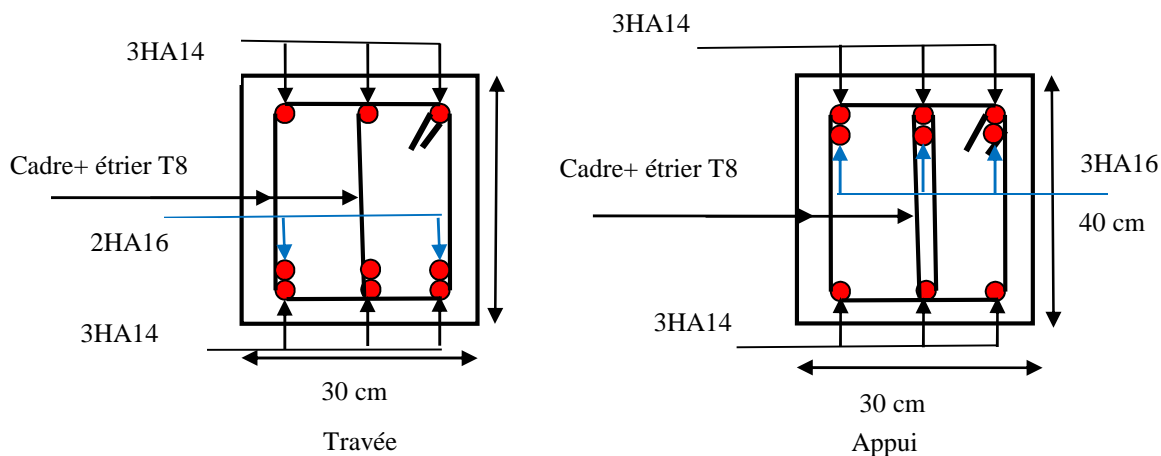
Schéma de ferrailage de la poutre principale étage courant
